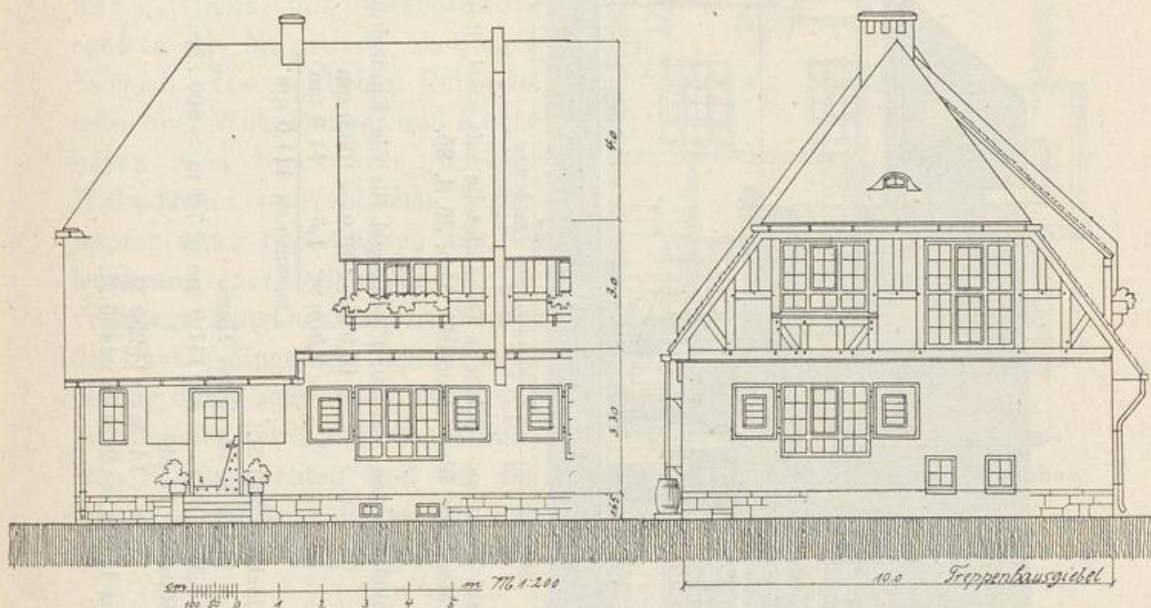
Symmetrisches Doppelhaus, nach Grundriß A Abb. 46 S. 48 gebildet.
